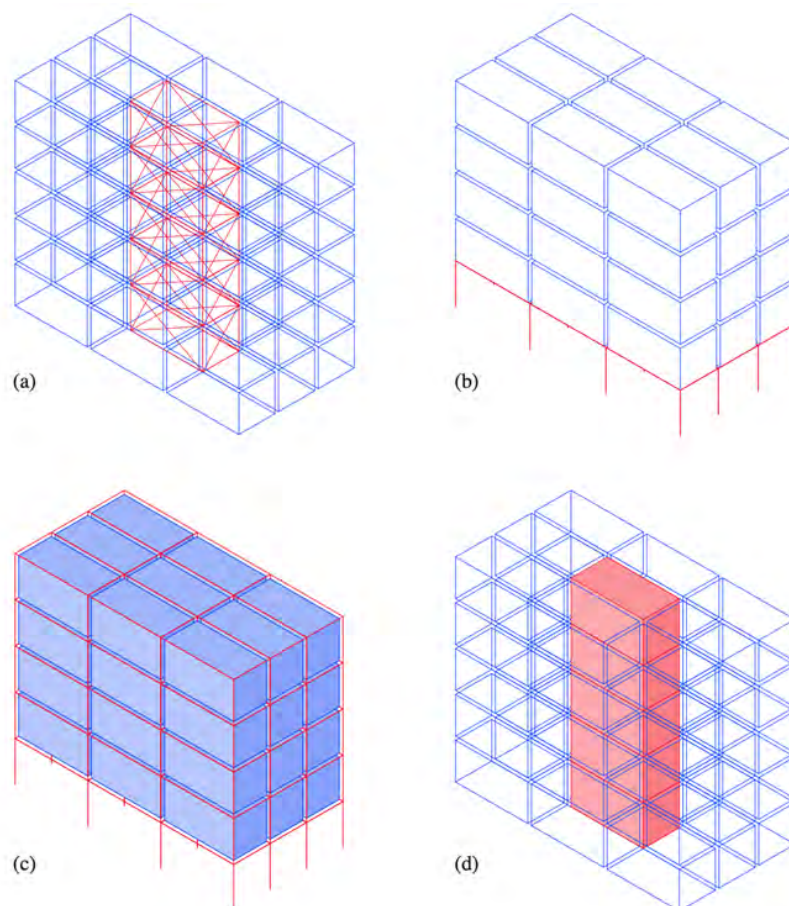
Tipos de LFRS em estruturas híbridas: (a) pórtico metálico contraventado, (b) pódio metálico ou betão, (c) módulo dentro de uma estrutura principal em aço/betão e (d) núcleo em betão.
